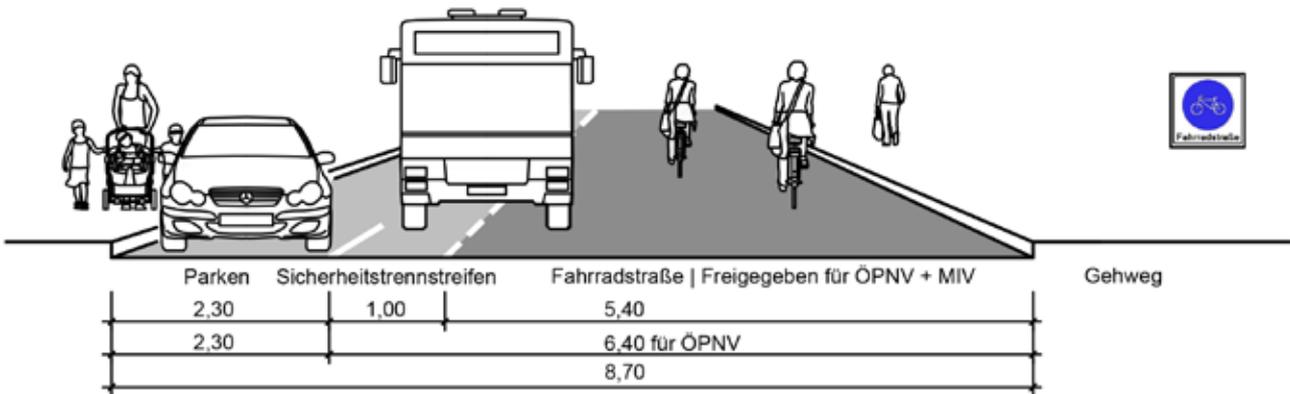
Straßenquerschnitt, Planung Holzhausenstraße
